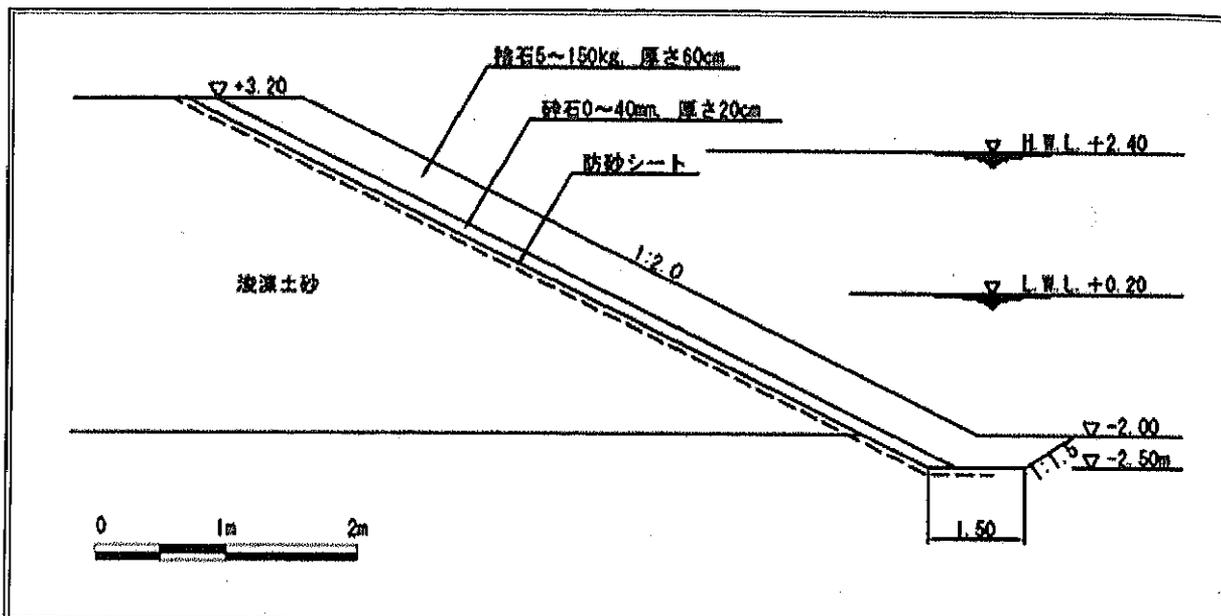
(18-1) 護岸の標準断面図 (護岸A:係留棧橋の陸側)
